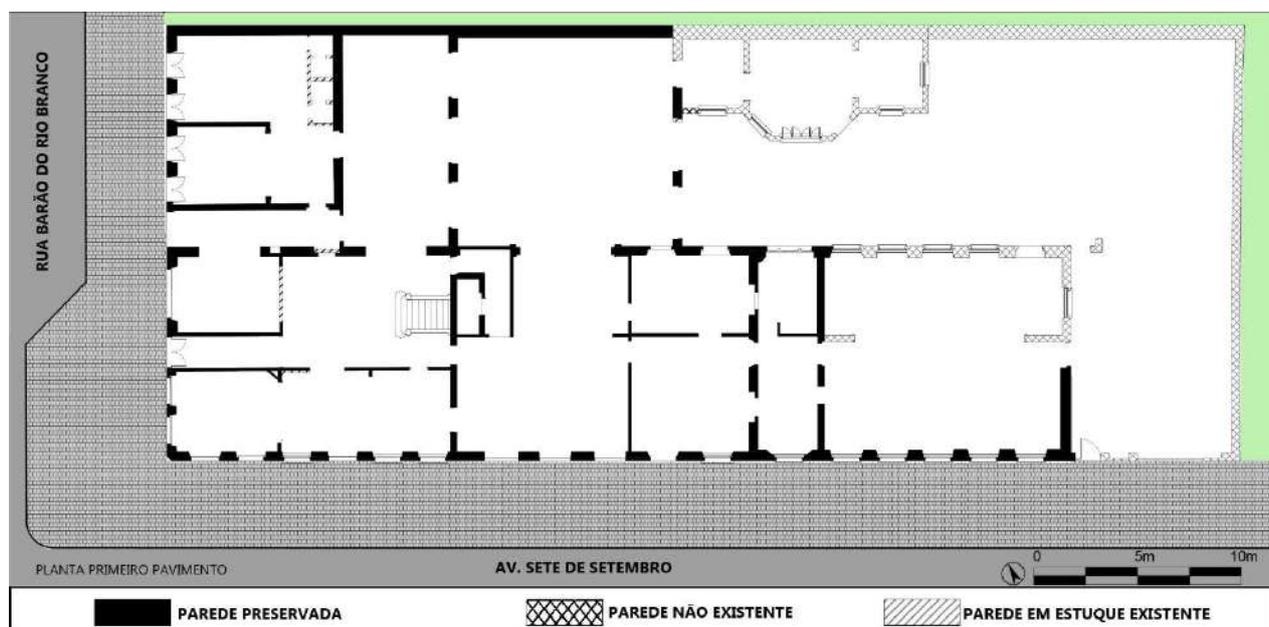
Planta baixa situação atual do primeiro pavimento. Fonte: a autora.
